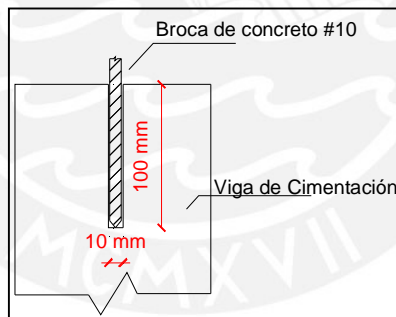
Corte transversal del anillo de cimentación para anclaje de refuerzo del murete M4.
